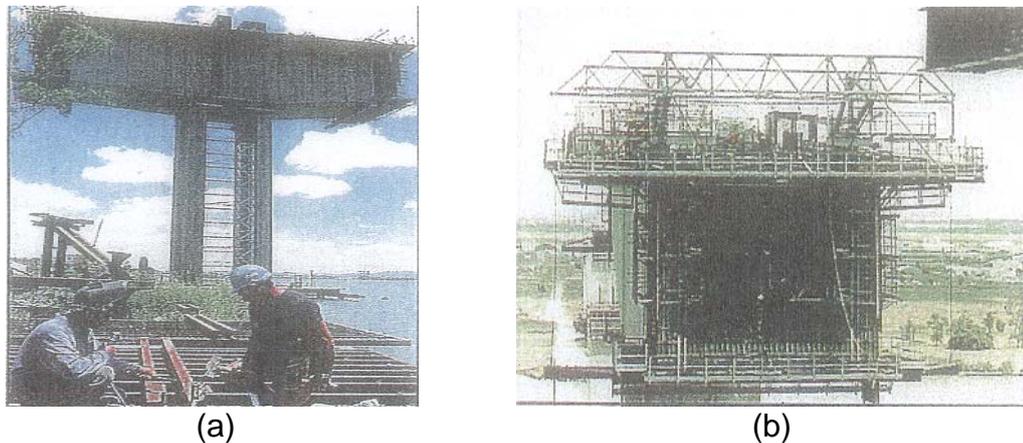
Detalhes das pontes rolantes no vão do balanço no pier 6. (a) Preparação da estrutura. (b) Montagem das pontes rolantes (ROTOLONE, 1986).
